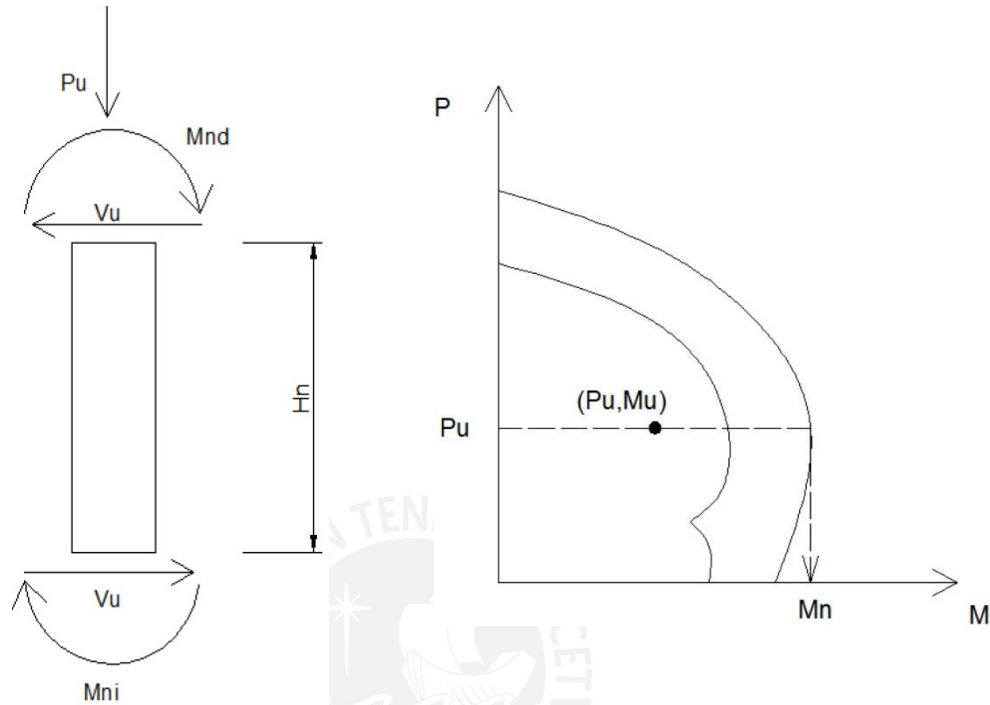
Fuerzas últimas en columnas y diagrama de interacción
